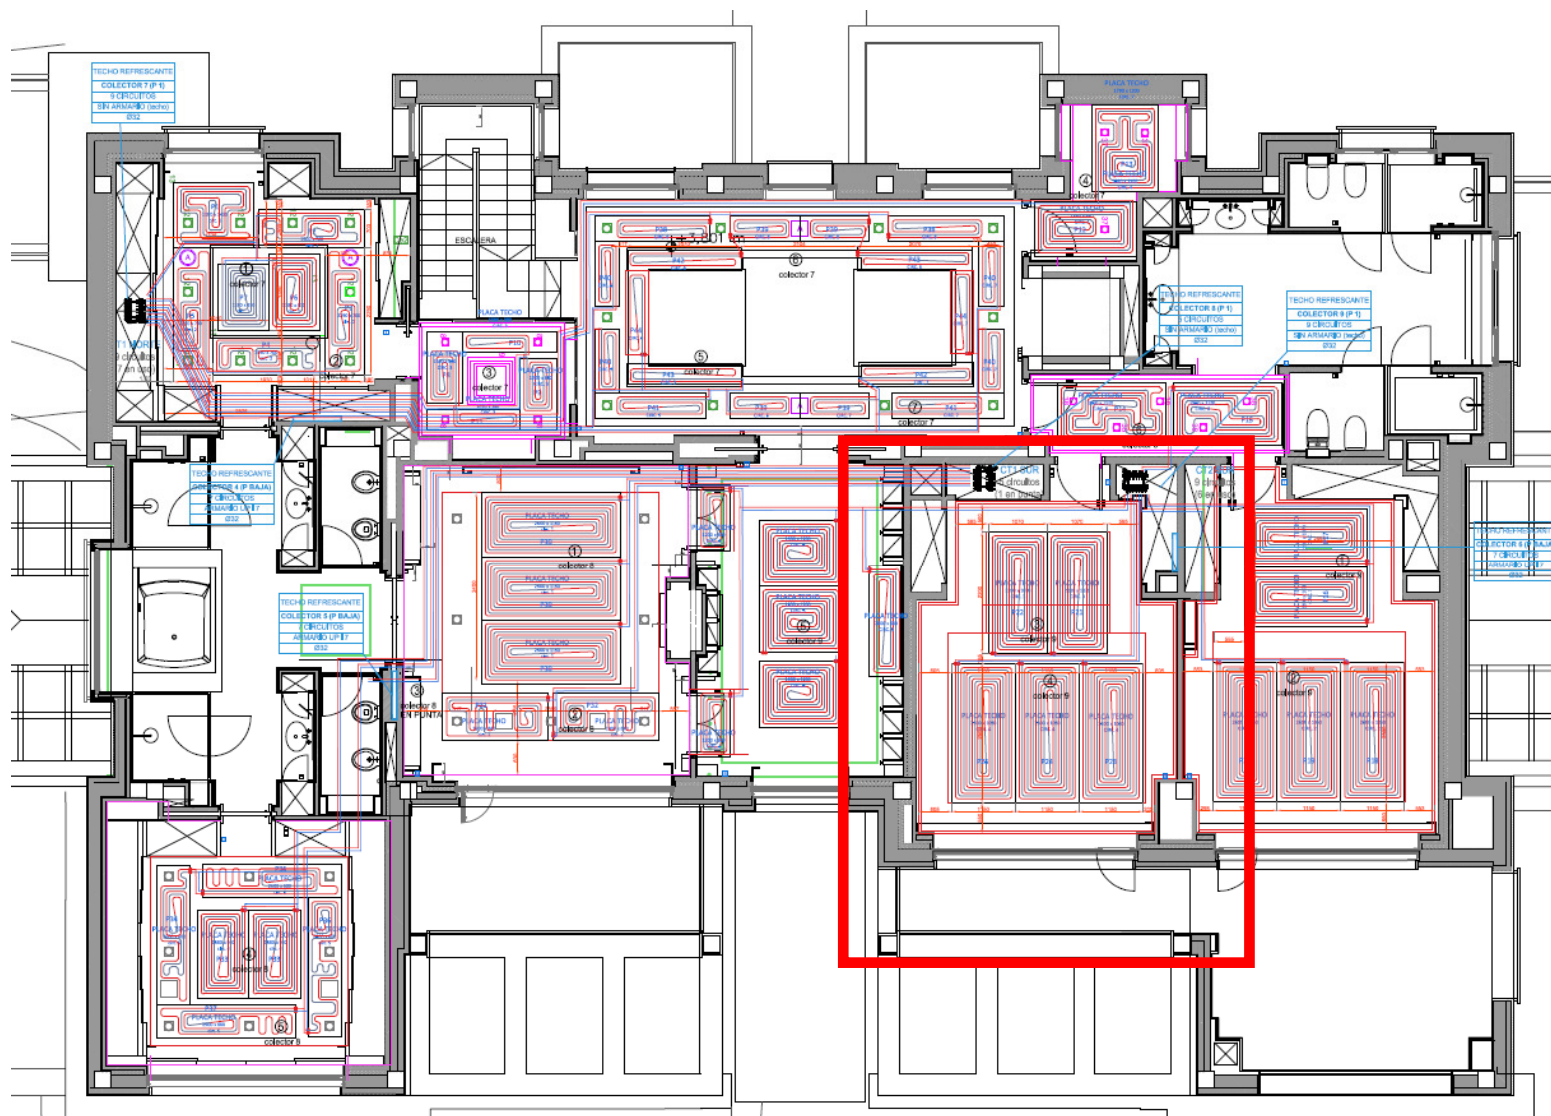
Plano de techo refrescane de planta primera en la vivienda objeto. Señalado el dormitorio infantil. Fuente: Elaboracion Propi
